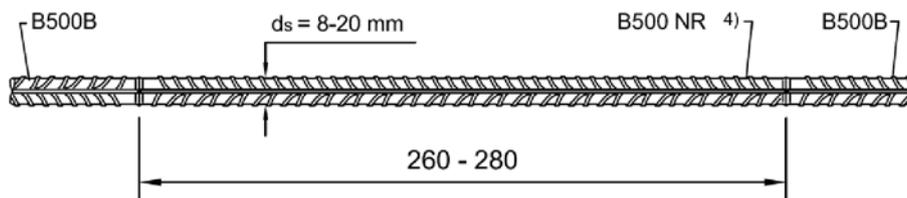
Zugstab mit geschweißten Stößen
